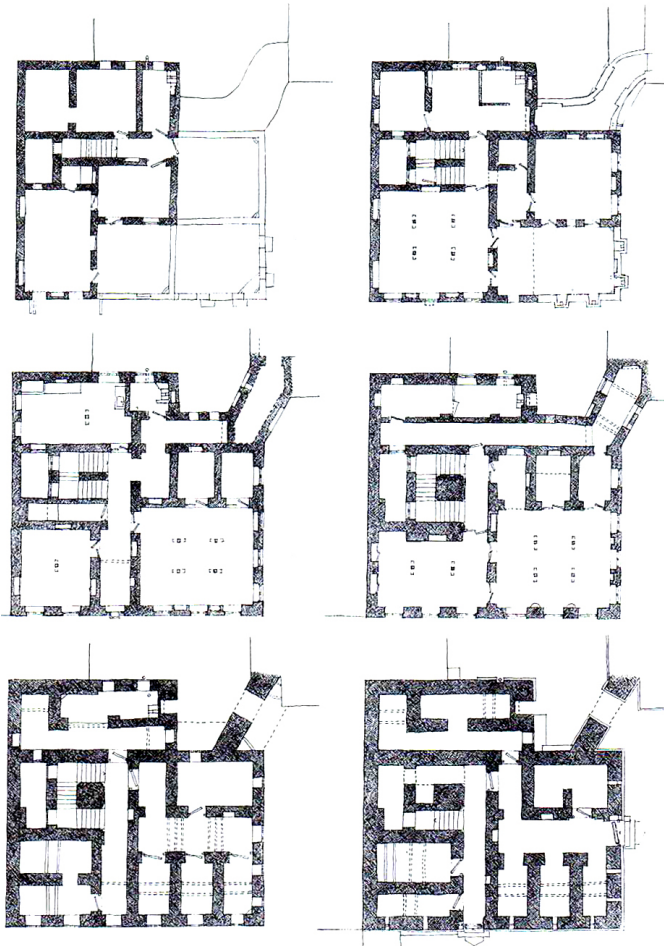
Grundriss eines Lehmturnhauses in Shibam mit immer dünner werdenden Lehmmauer bis in die obersten Geschosse. Nachteil ist ein höherer Flächenbedarf in den unteren Geschossen.
